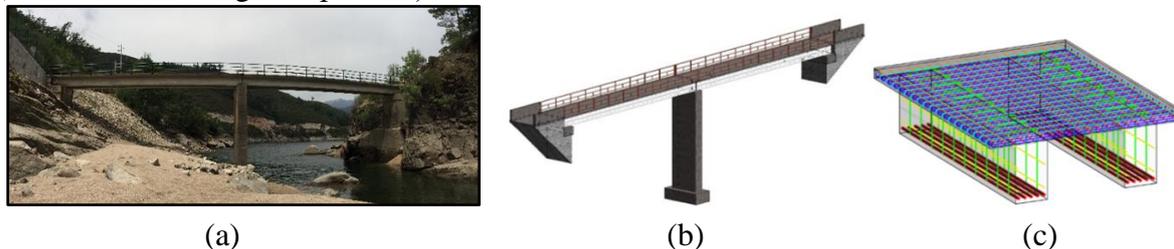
a) Aspeto geral da Ponte do Saltadouro; b) vista geral do modelo BIM; c) pormenor de armaduras numa parte do modelo
